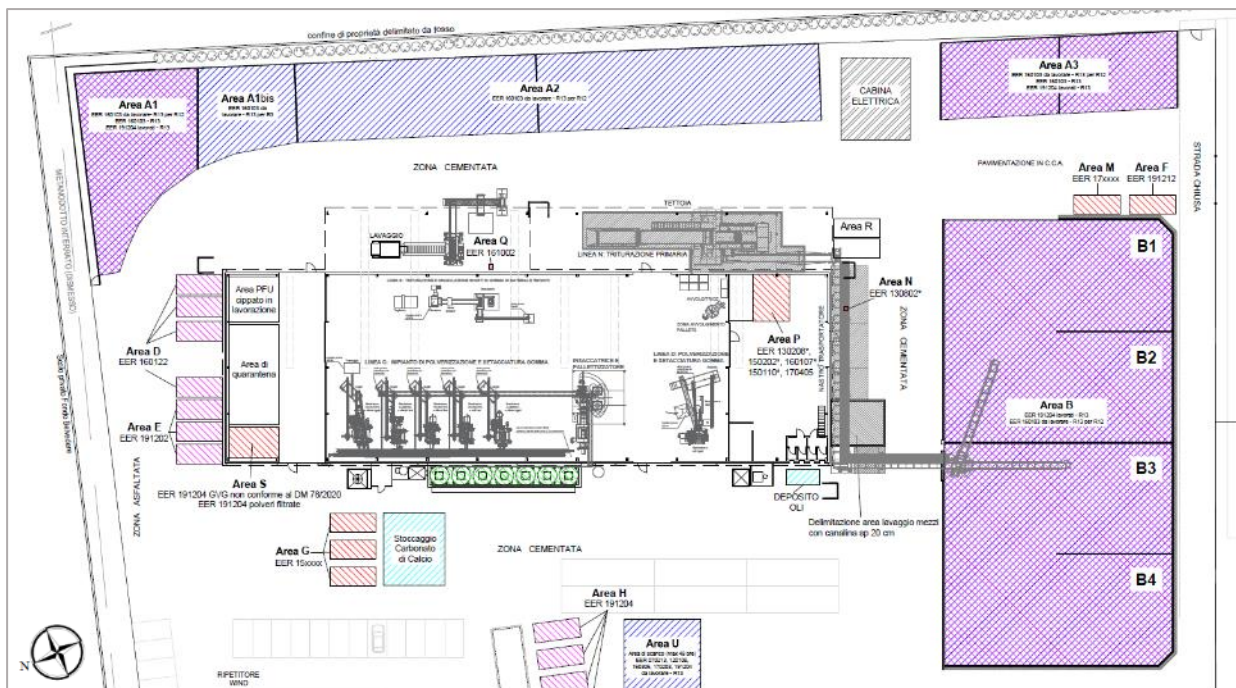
Stralcio della planimetria depositi e stoccaggi
